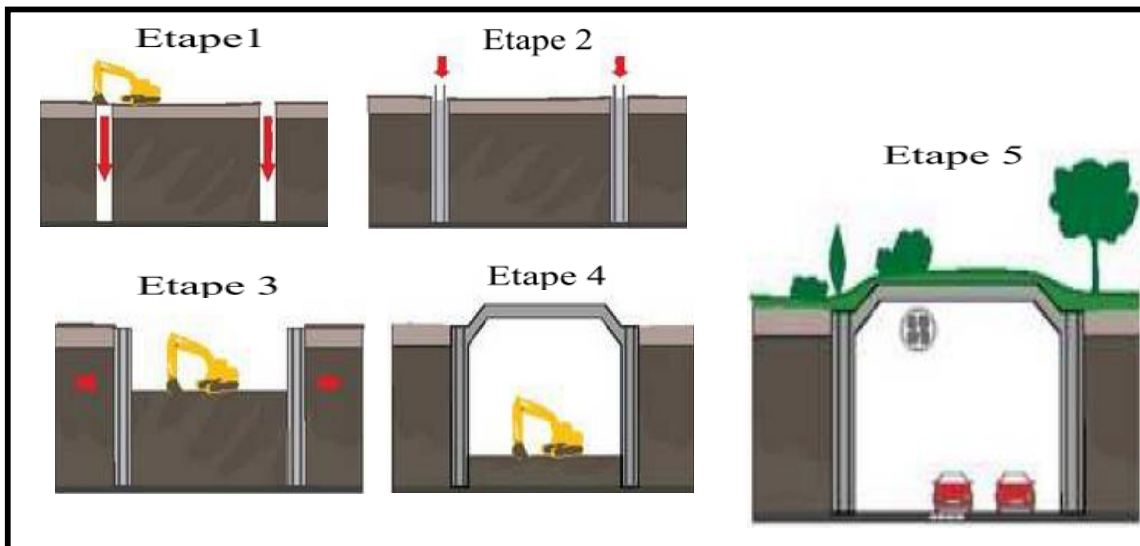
Les étapes de construction des parois moulées de tranchée couverte avec plancher.
